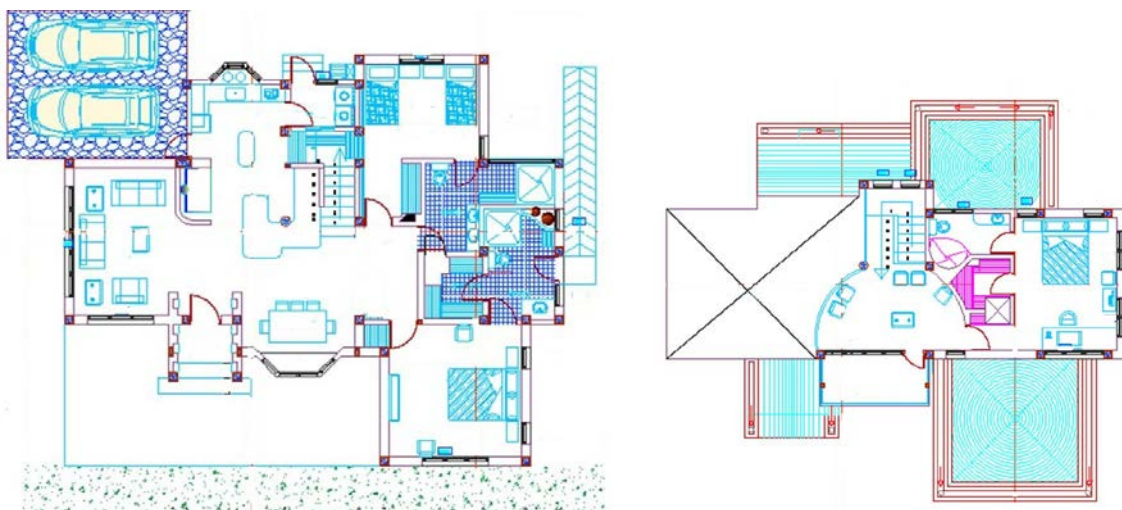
Planta arquitectónica Casa UE / primero y segundo piso
